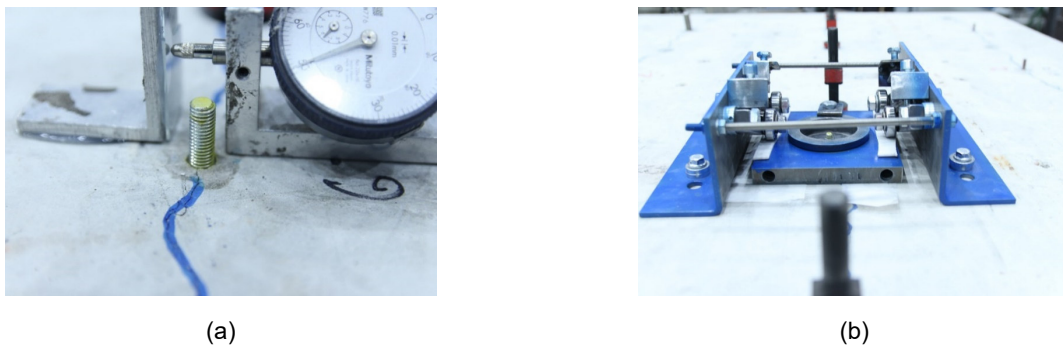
Risskeilplatte: (a) Positionierung von analogen Rissuhren, (b) Befestigung der Querkzugplatte auf der Betonoberfläche
